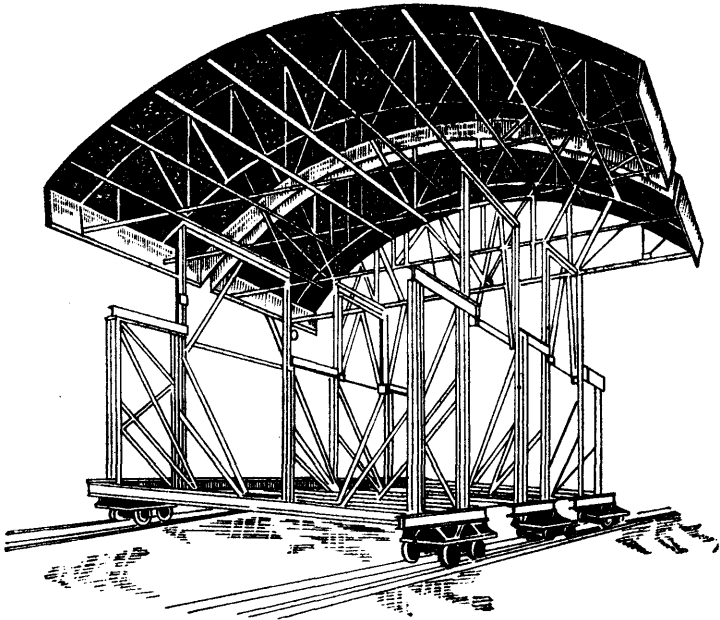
Катящая опалубка для бетонирования сводов-оболочек.
